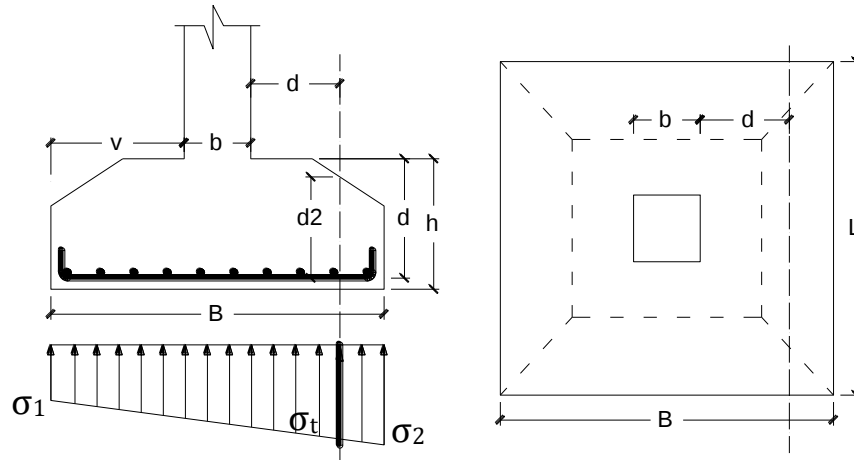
Cálculo a Corte en zapatas rígida (caso II)
